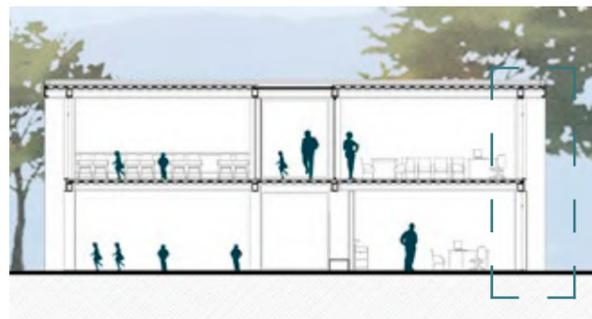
| Sistema constructivo aula colegio | Fuente: Elaboración Propia
